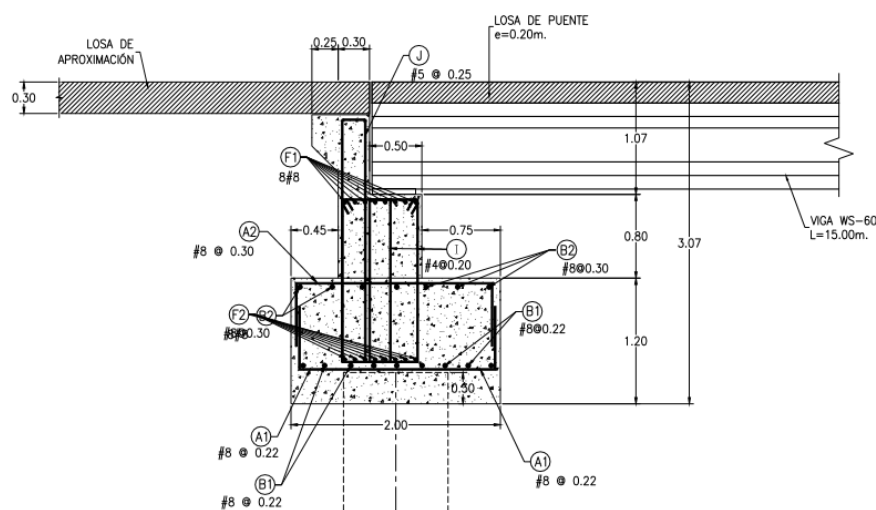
Detalle estructural de sección de estribo, 2da calle.
